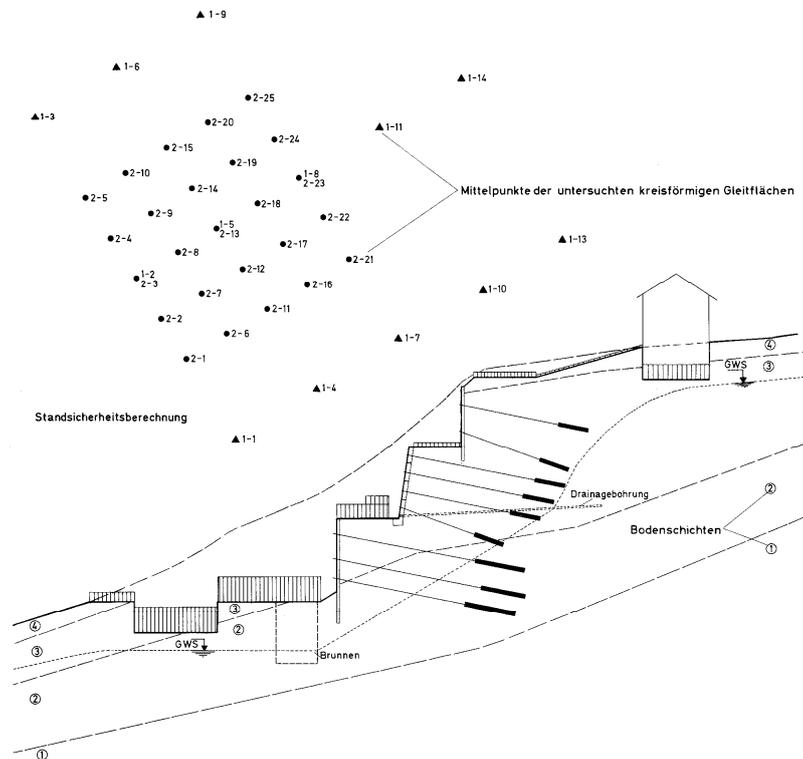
Mittelpunkte von denkbaren Böschungsgleitkreisen [5]
